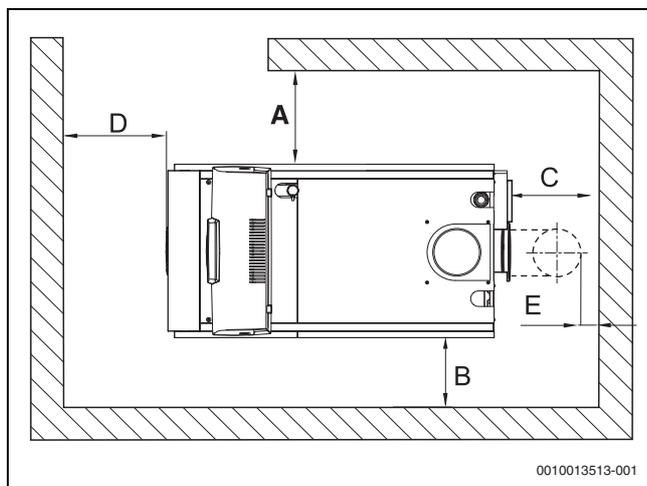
Distanze dalle pareti nel locale di posa (versione sinistra)
